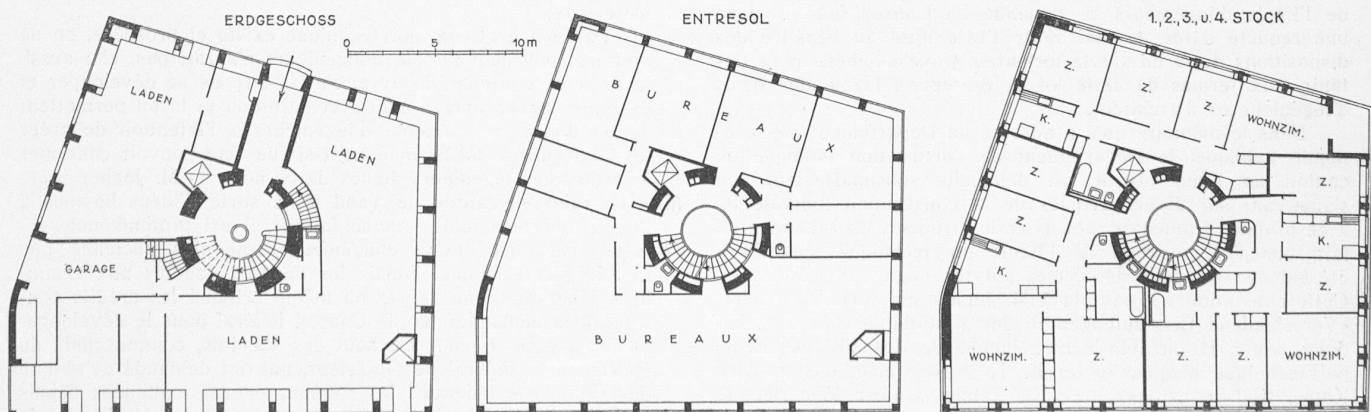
Geschäftshaus und Wohnhaus Burgertor in Luzern. — Arch. Armin Meili, Luzern, Ing. Werner Siegfried, Bern. — Grundrisse 1 : 400.
